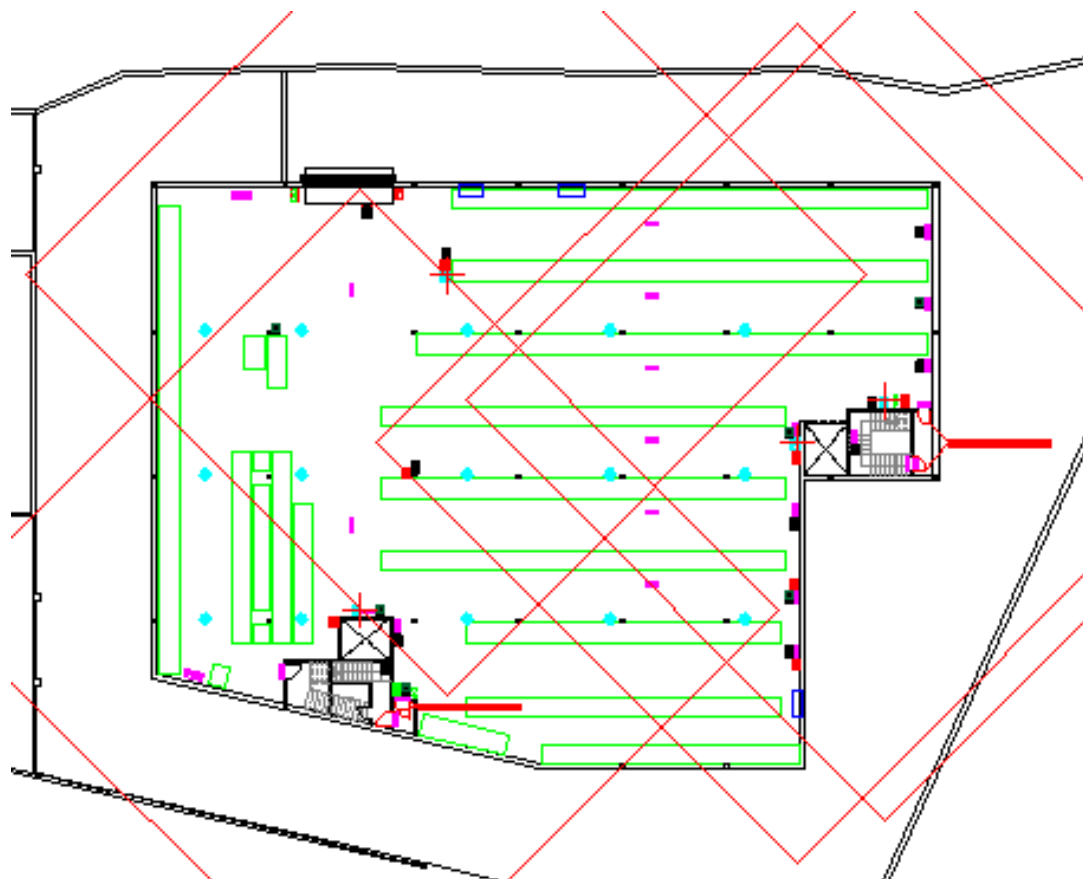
Superficie cubierta por las BIE's en la planta sótano del edificio Almacén
